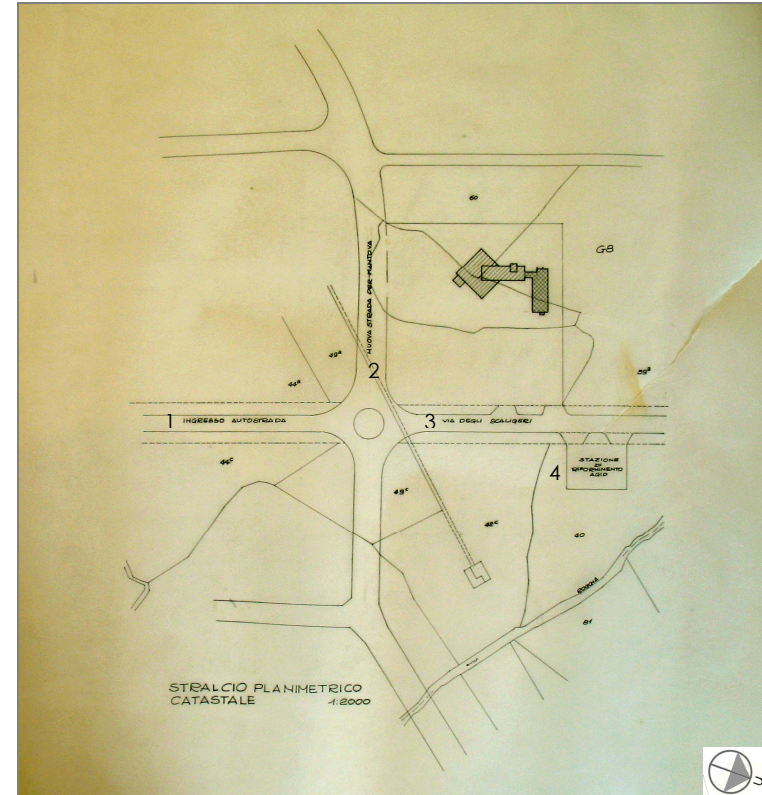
stralcio planimetrico catastale (fonte CSAC – stralcio tav. 1, archivio n. 400-1, rielaborazione f.m.)
